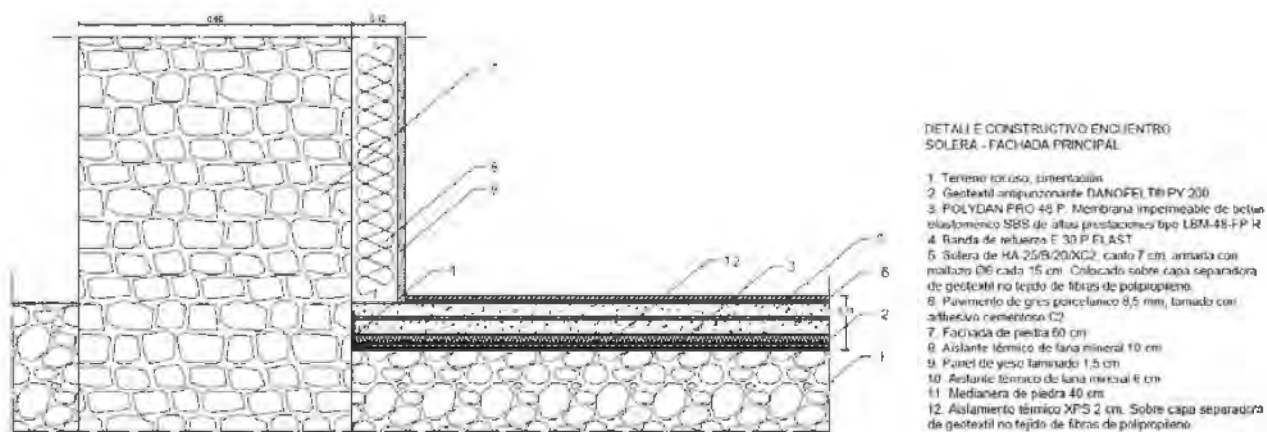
Detalle constructivo solera – fachada principal. Fuente: propia.
